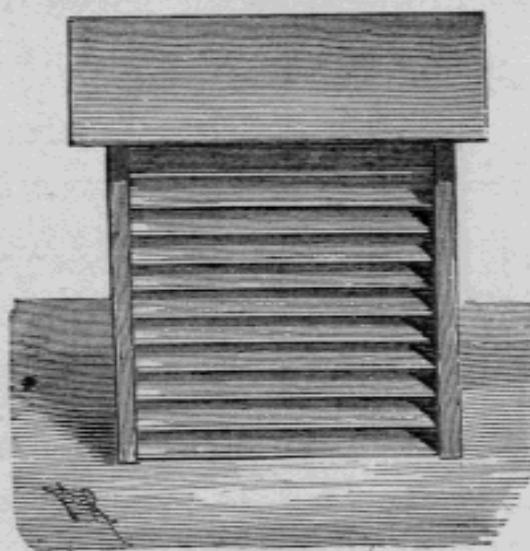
Pavillon ventilateur, toit à longs pans.
